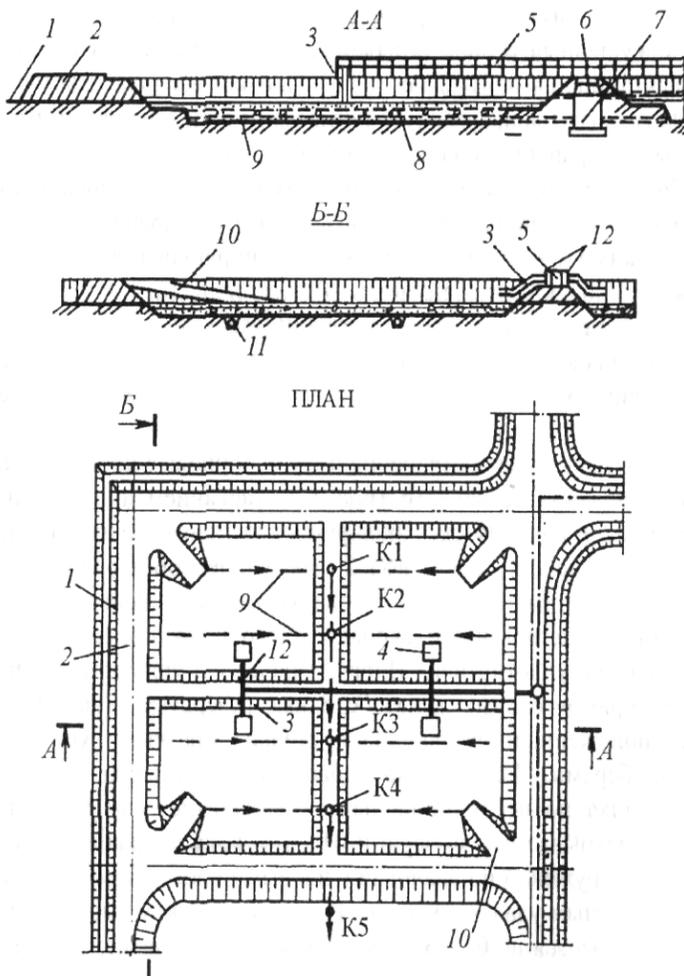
Иловые площадки на естественном основании с дренажом:
